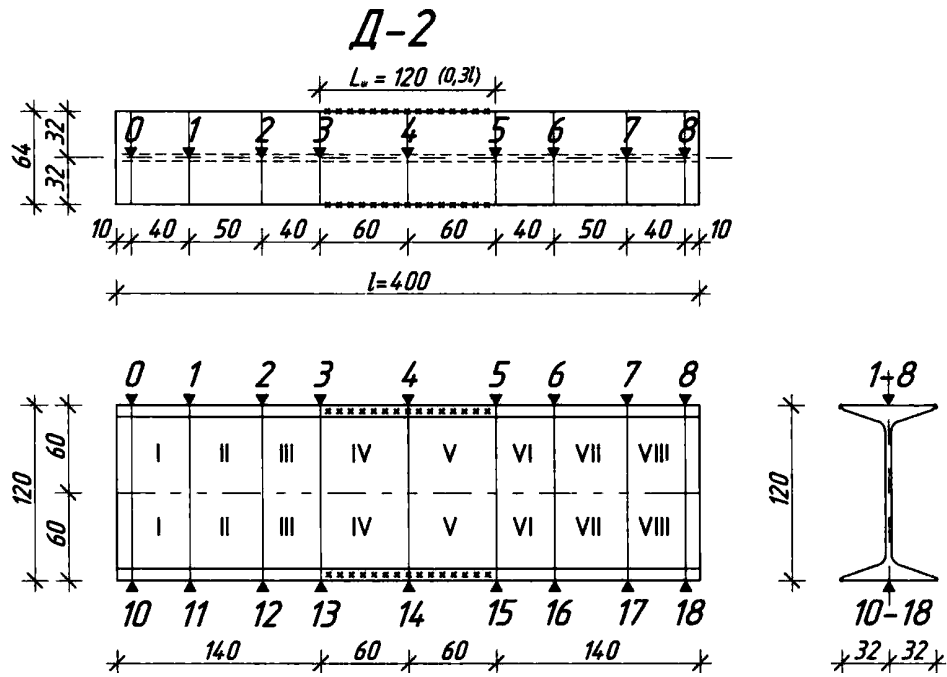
Схема наплавления сварных валиков в образце Д-2
